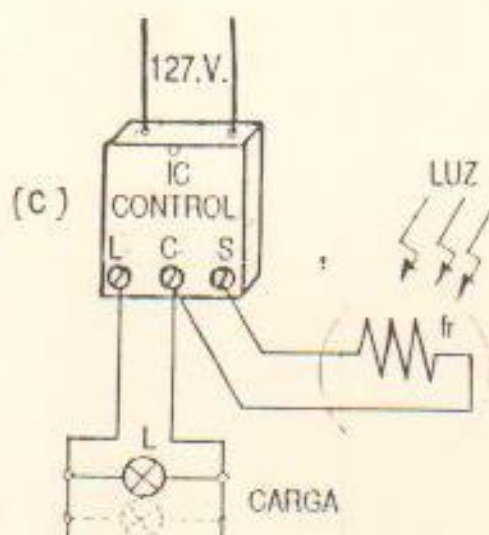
COMPONENTES DEL INTERRUPTOR CREPUSCULAR [I.C.] 127.V. ca
